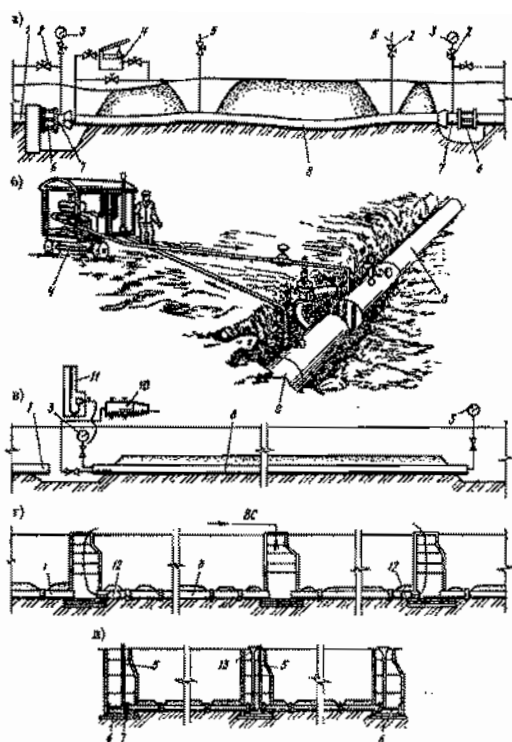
Схема испытания трубопроводов: 1 - уложенный трубопровод; 2 - вентили (затяжки); 3 - манометры; 4 - гидравлические прессы; 5 - трубки для выпуска воздуха; 6 - временные упоры; 7 - заглушки; 8 - испытываемый трубопровод; 9 - испытанный участок; 10 - компрессоры; 11 - ртутный манометр; 12 - заглушки (резиновые баллоны); 13 - стойки для заливки водой
